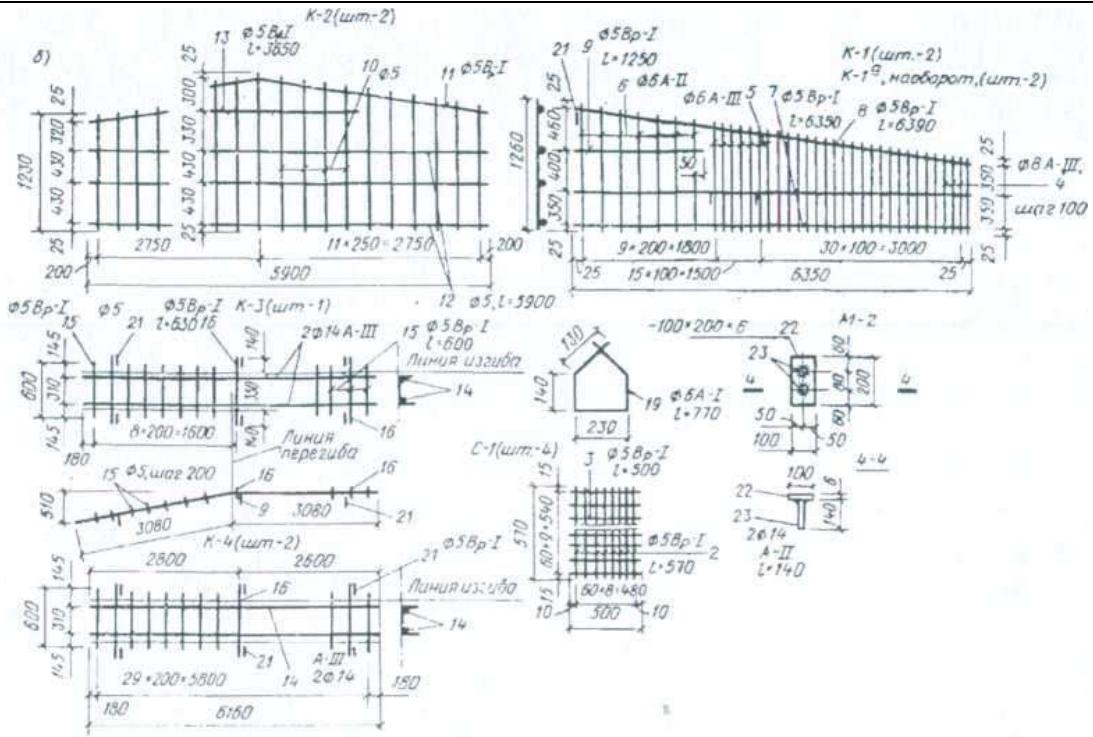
Конструкция железобетонной балки $L=18$ м
